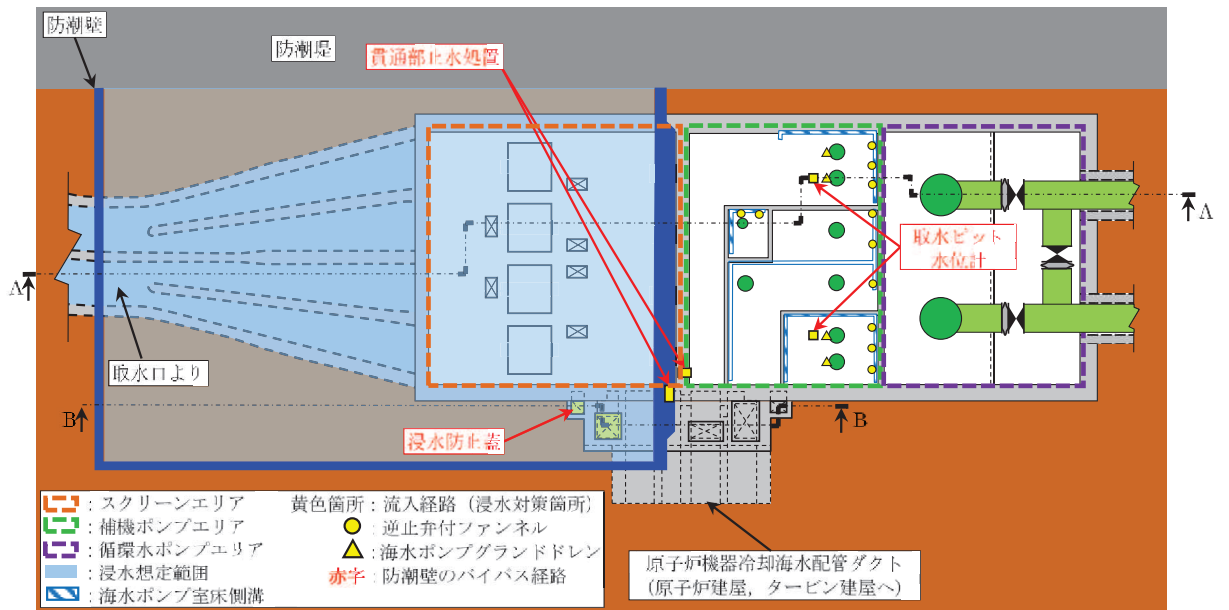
(1) 第 2 号機 海水ポンプ室 浸水対策配置図 (平面図)
